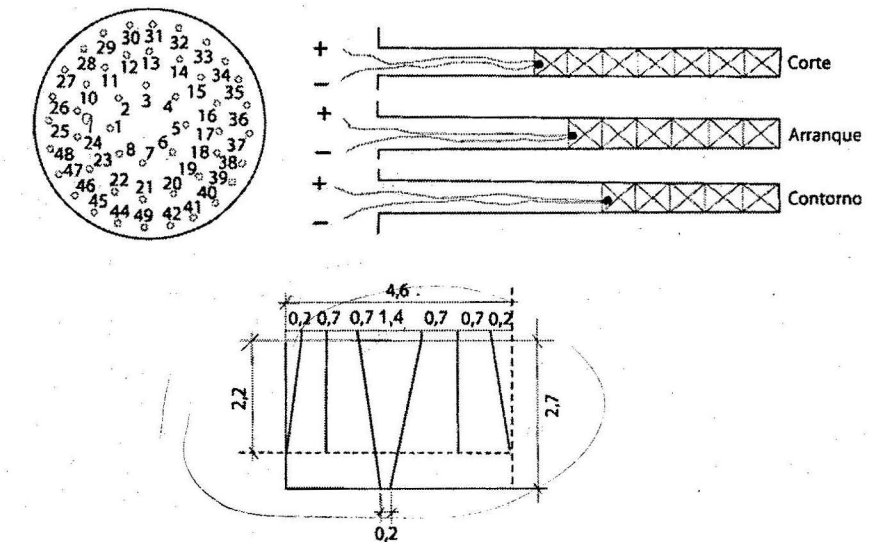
Esquema de disposición de los barrenos en el pasaporte en el laboreo de las excavaciones verticales.
